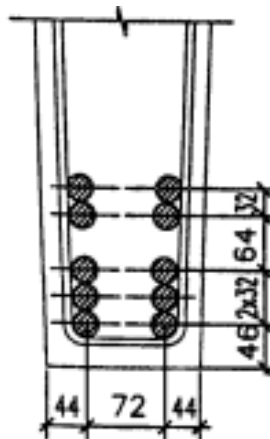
Армирование растянутой зоны балки Б1500.130.93-Т28АШс
